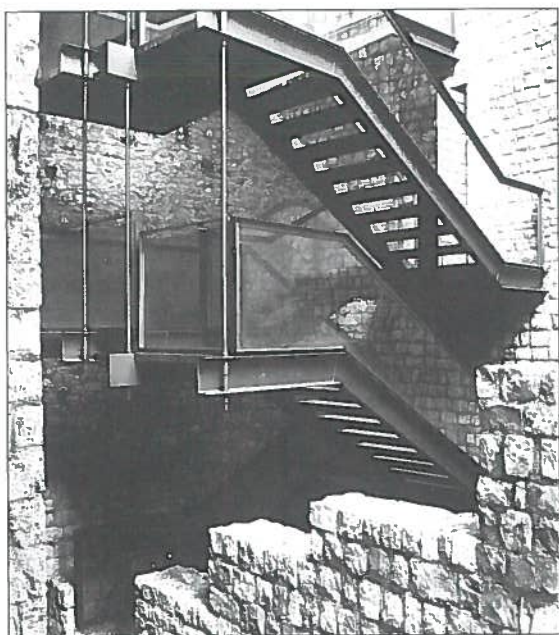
Restauro di Castello Caetani a Trevi. Vista delle prime rampe della scala esterna.
